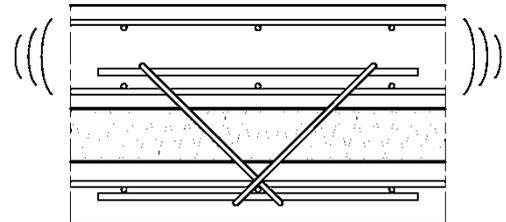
Nachverdichten der oberen Schicht. Nach dem Einbau der Anker und Nadeln ist ein Nachverdichten des Betons erforderlich. Der Abbindeprozess des Betons muss zeitlich berücksichtigt werden.
